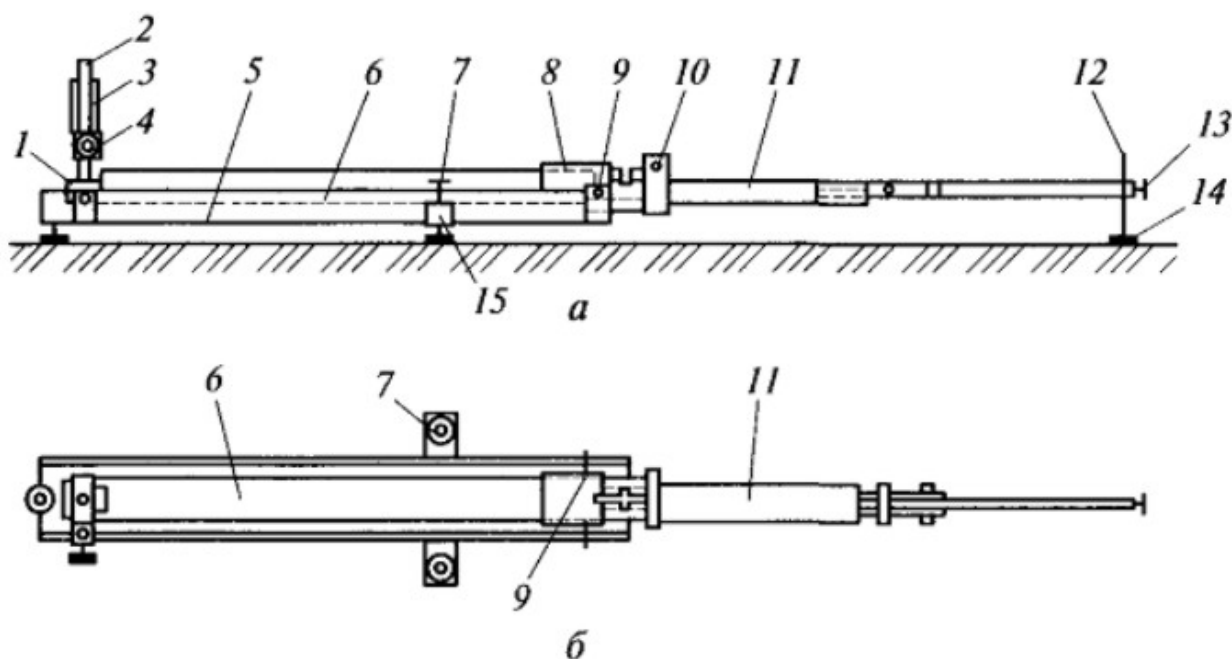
Рычажный прогибомер МАДИ - ЦНИЛ:
